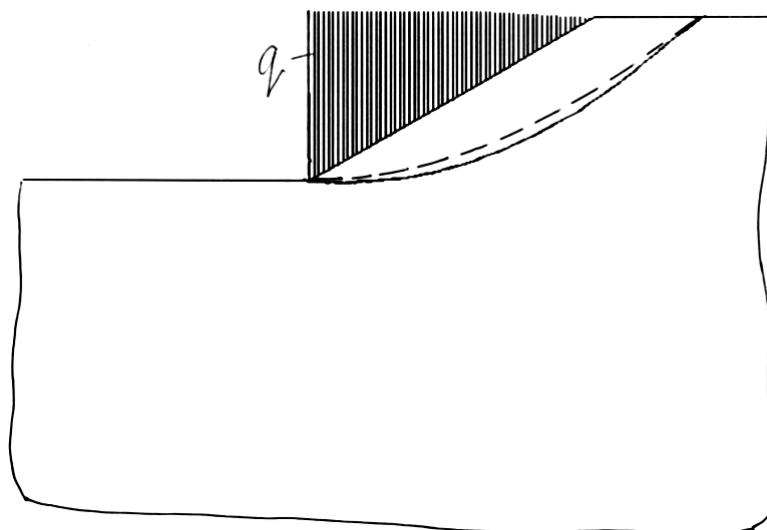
Расчетная схема склона, нагруженного вертикальной треугольной нагрузкой.
